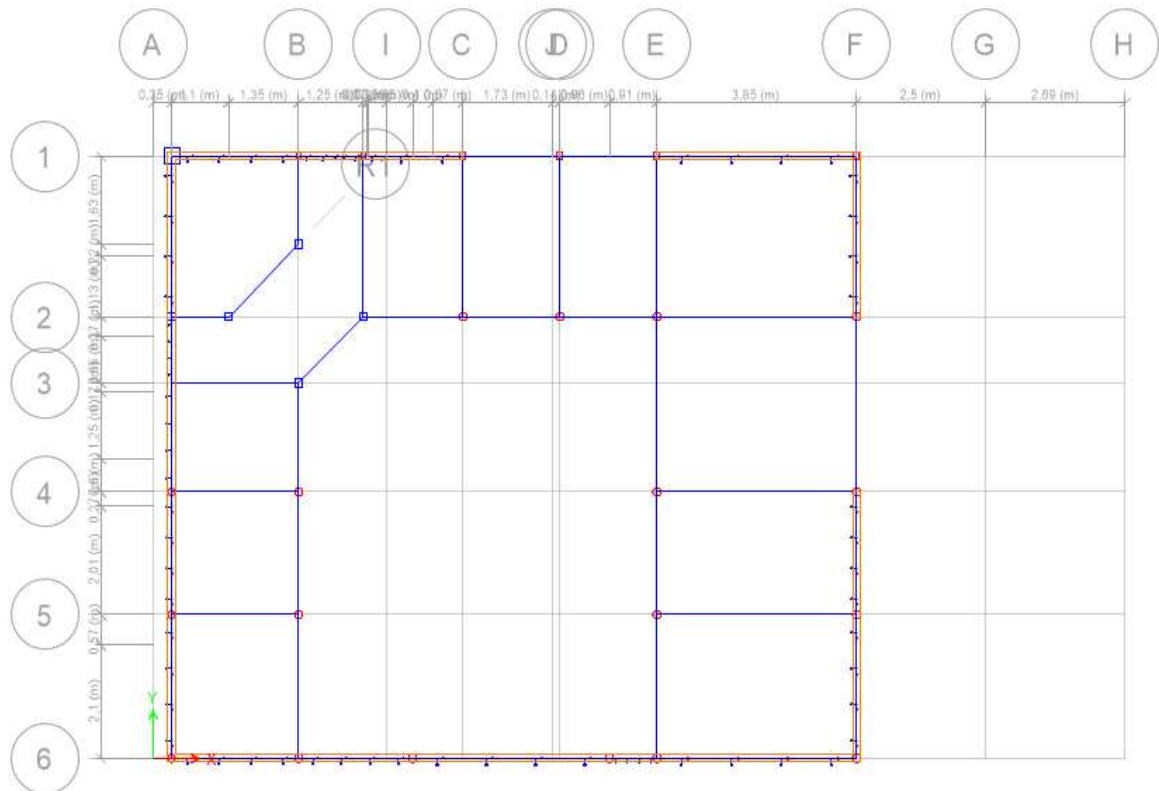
Planta segundo piso, se observan los muros de albañilería.
